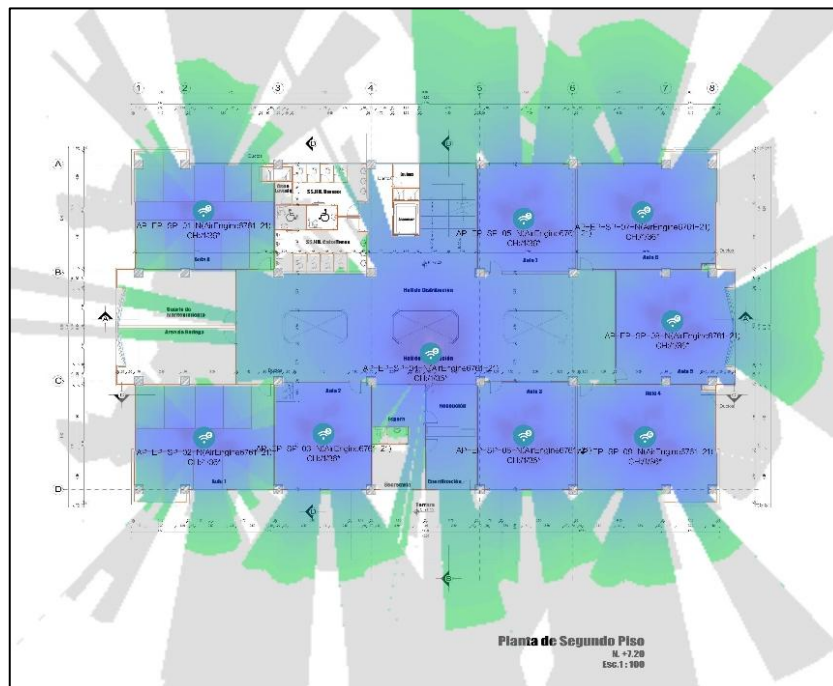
Edificio de Posgrados - Planta de Segundo Piso
